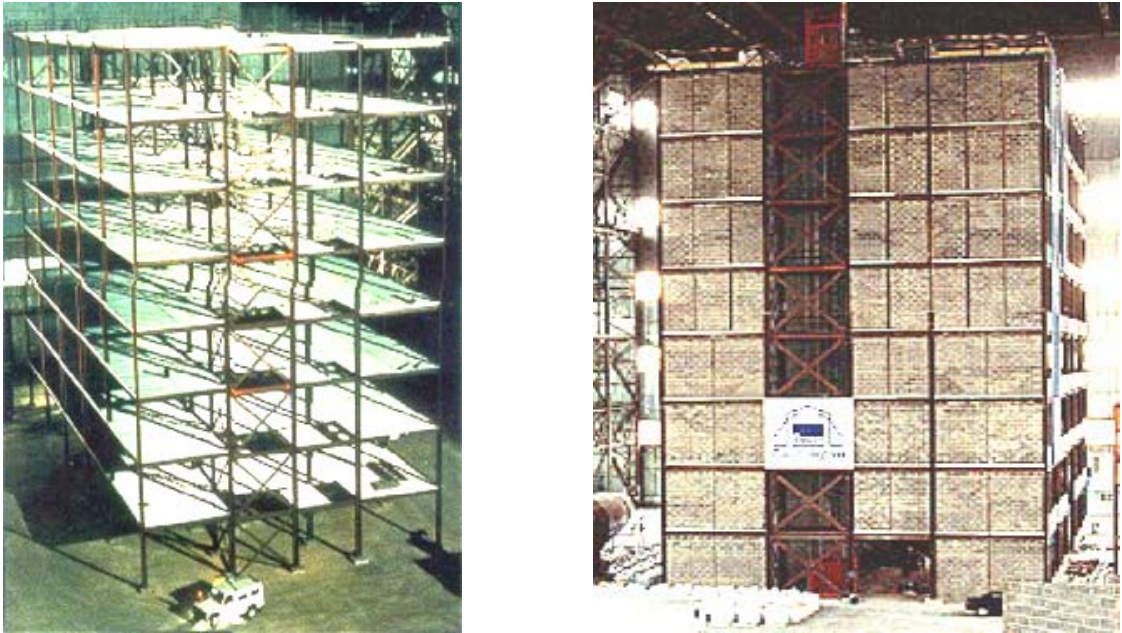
Estrutura de 8 (oito) pavimentos construída em escala real.
